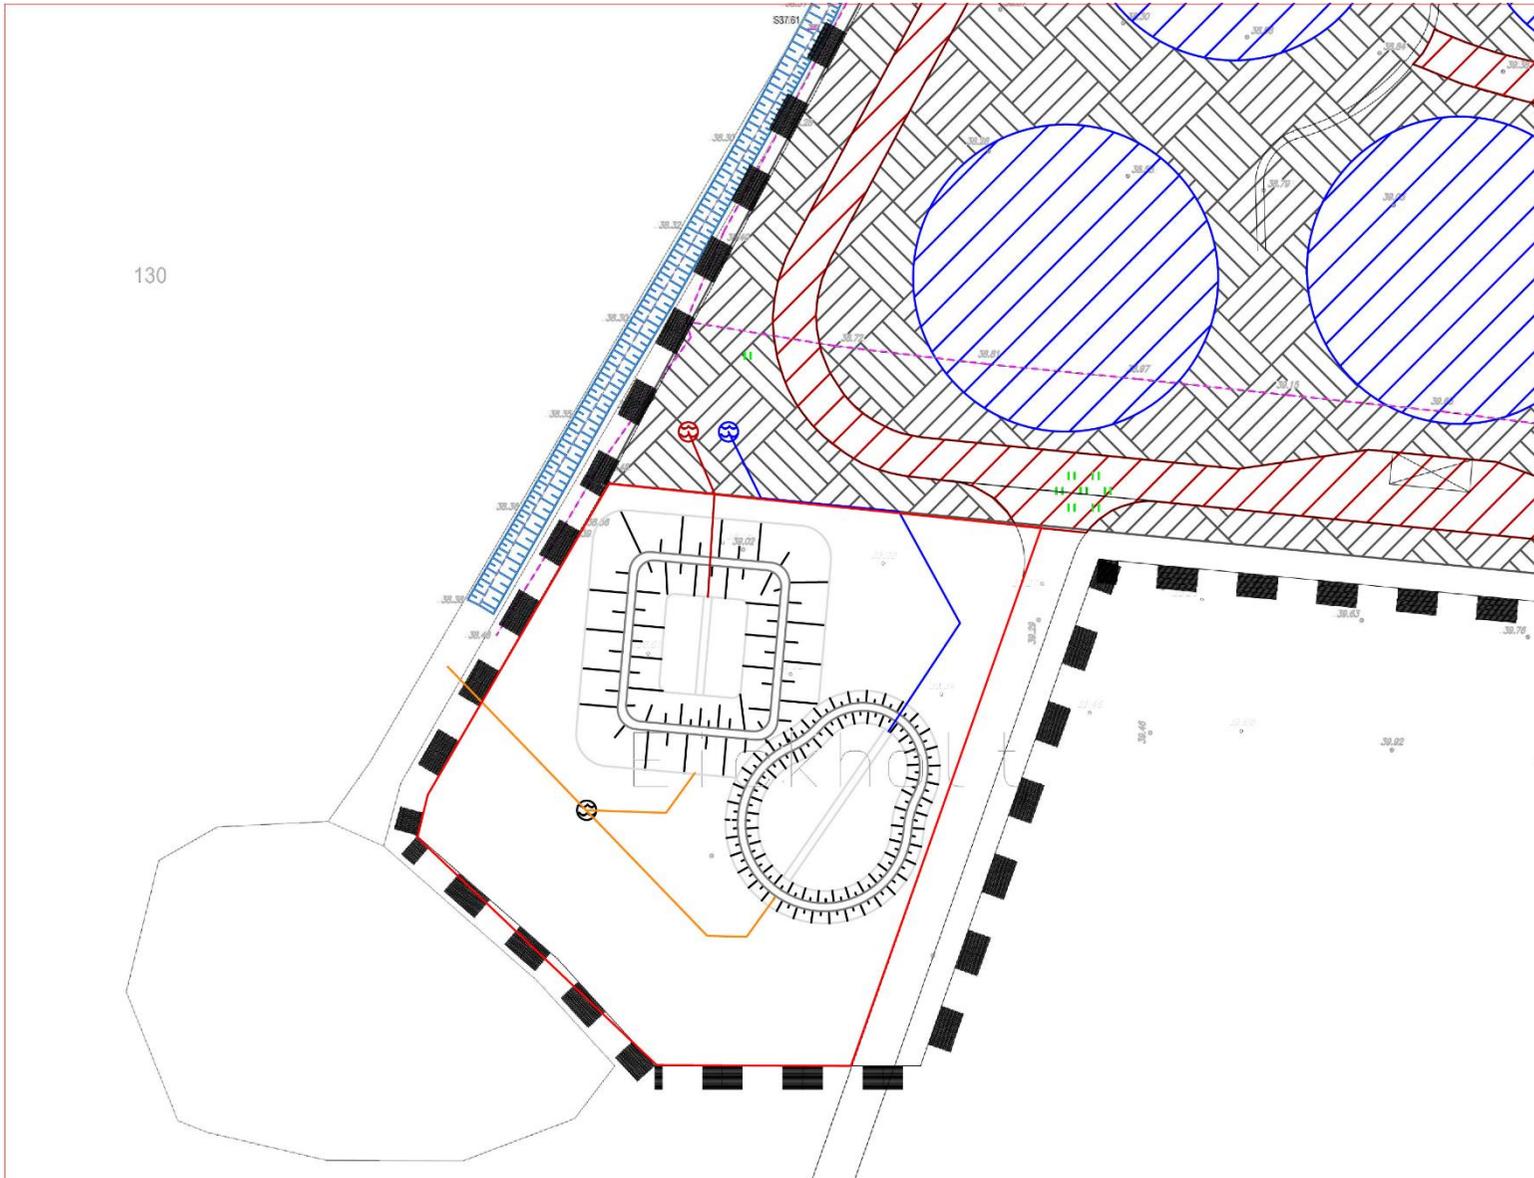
Vorläufige Lage und Größe der Baufläche zum Rückhalt und Behandlung der Niederschlagsabflüsse
